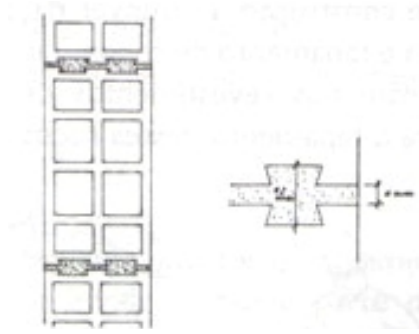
Formato da junta horizontal (Fonte: Ferreira *et al*, 2008).
